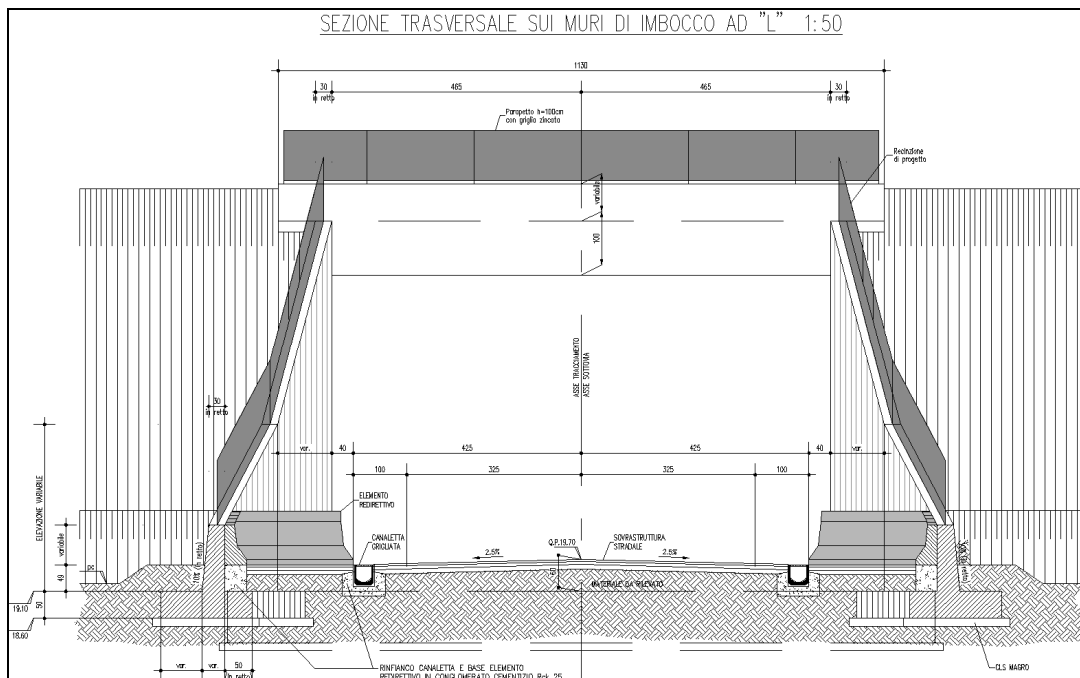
SEZIONE TRASVERSALE SUI MURI DI IMBOCCO AD "L"
